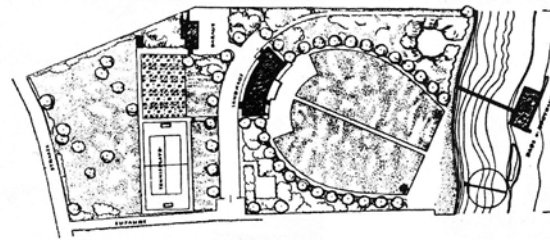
Seewalchen am Attersee, Litzlberger Straße 37, Haus Eichmann, errichtet von Clemens Holzmeister 1926–1928, unter Denkmalschutz, rechts: Lageplan und Grundriss
